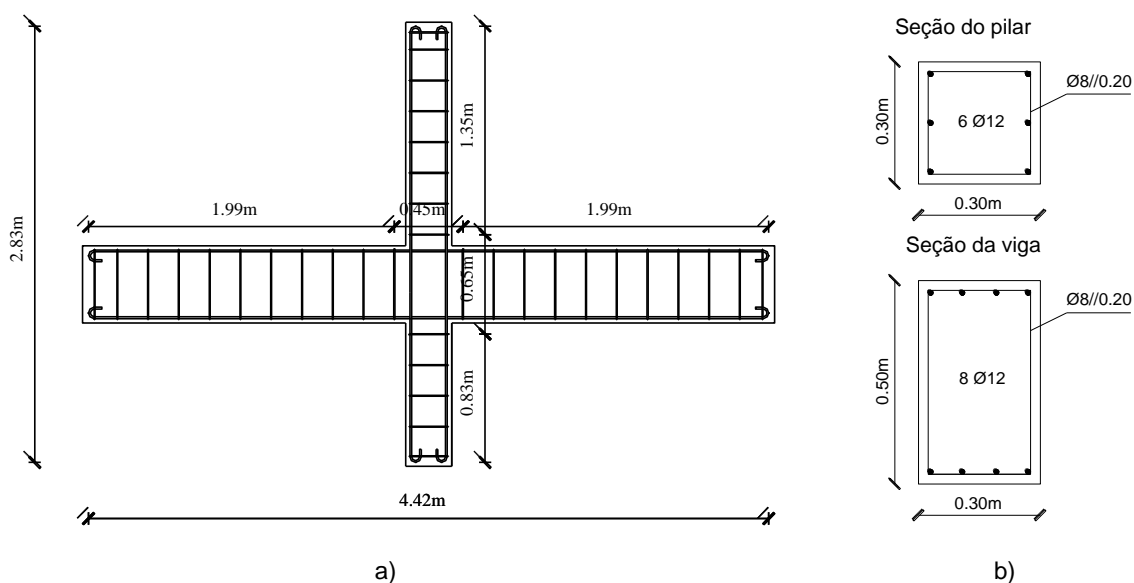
Armadura do provete IPA; a) em planta; b) em corte.
